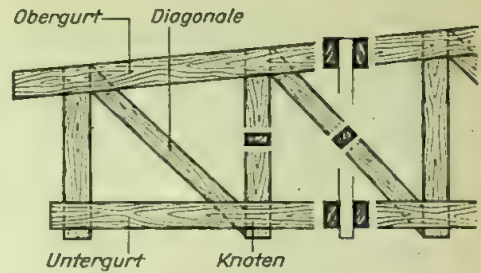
Genagelter Fachwerkträger (trapezförmig)
